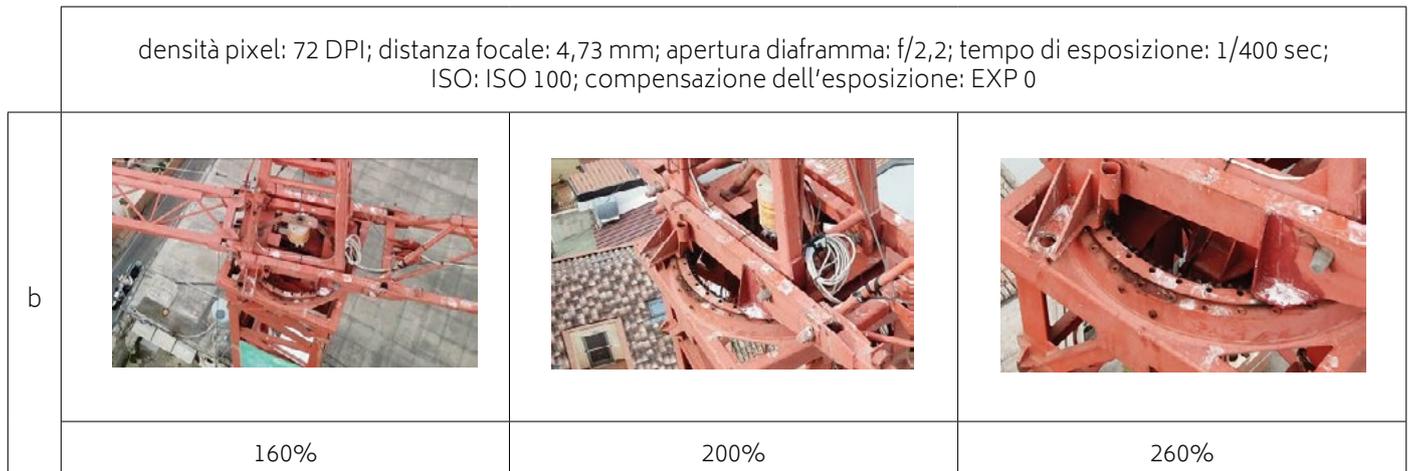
Particolare della verniciatura di protezione della struttura metallica
